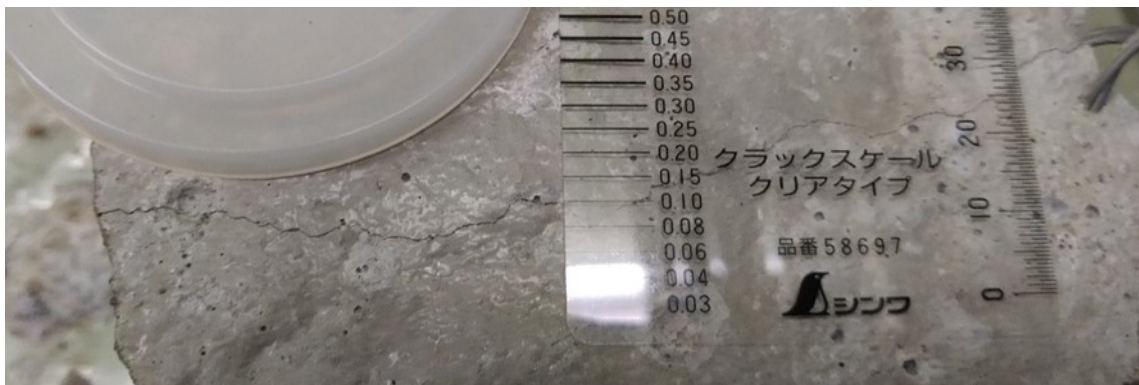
尿素水溶液塗布前のひび割れの様子
